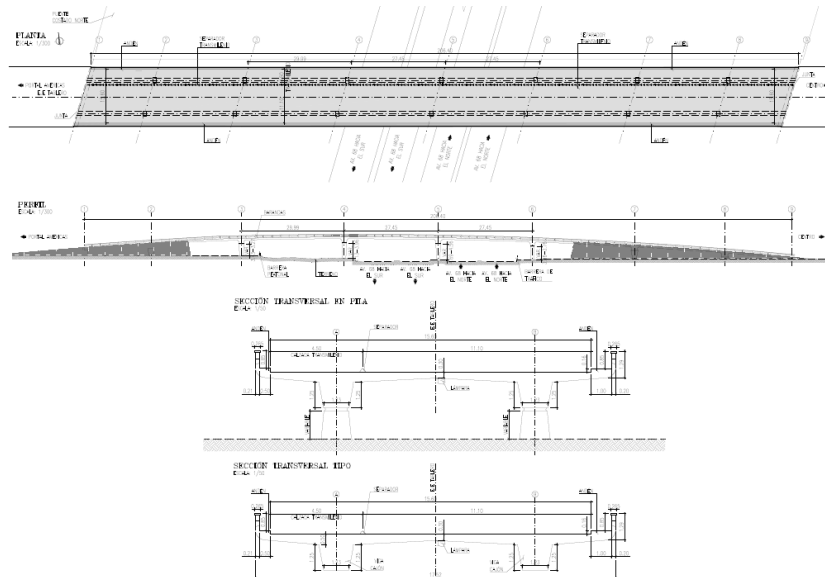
Reforzamiento estructural, Intersección AV. Américas Con AK. 68, costado sur.
